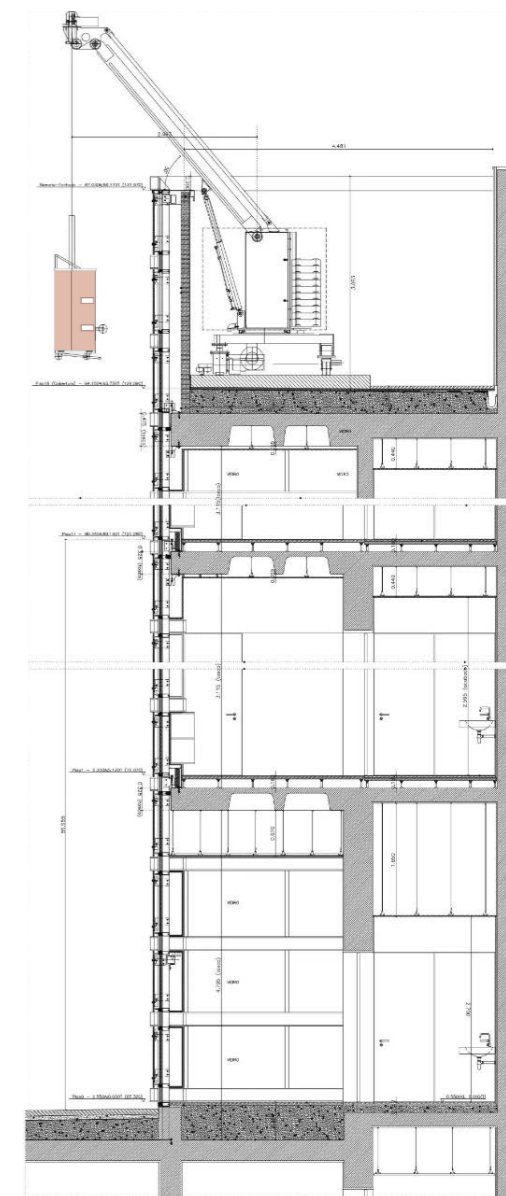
El gráfico muestra un corte de la torre Burgos, en donde Souto de Moura prevee el uso de maquinaria en el Sistema de ensamblaje de piezas, Edificio Burgo. Fuente: Eduardo Souto de Moura
